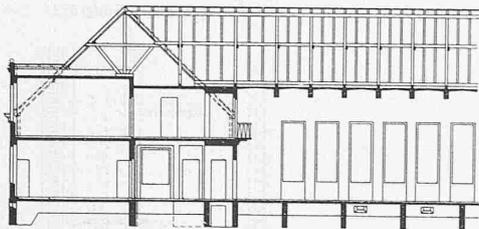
bis 3. Grundrisse und Längsschnitt der Turnhalle in Wülflingen. — Masstab 1 : 400.
